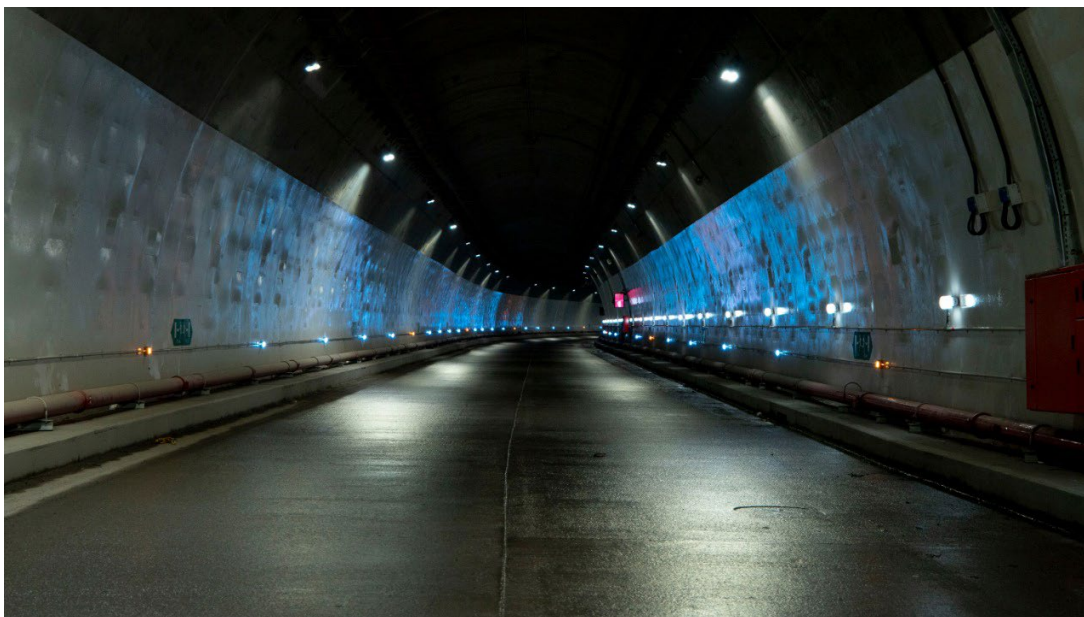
Geometría, equipamiento y estado final del Túnel – Cruce Cordillera Central
